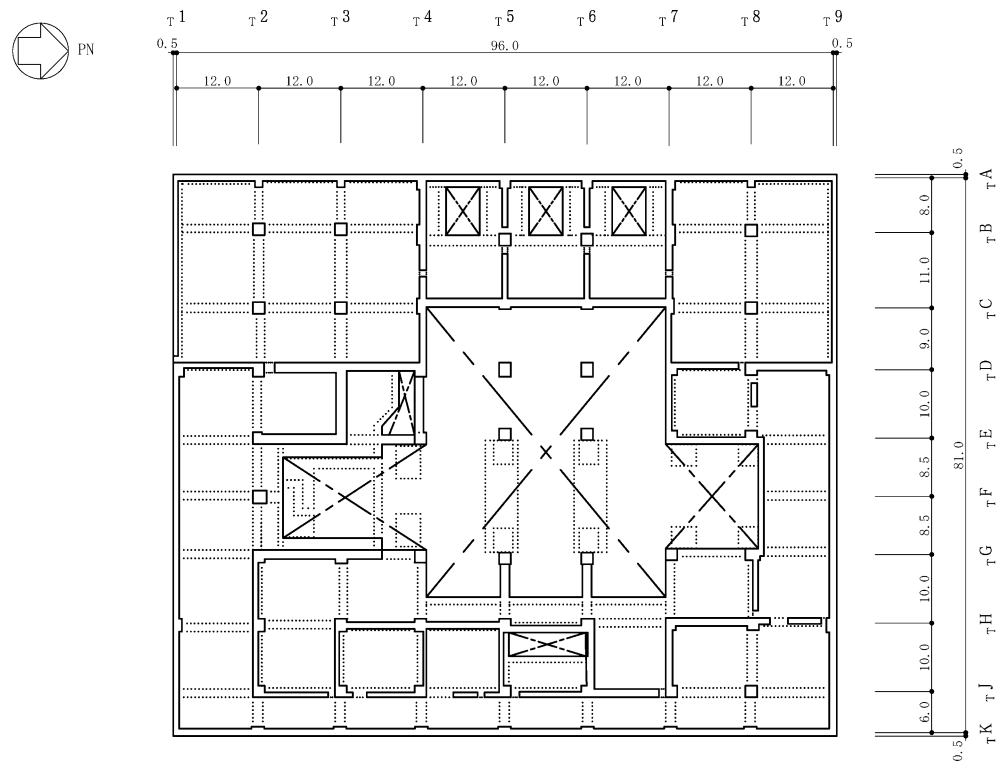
タービン建屋の概略平面図 (B1F, T. M. S. L. 4. 9m) (2/6) (単位 : m)
